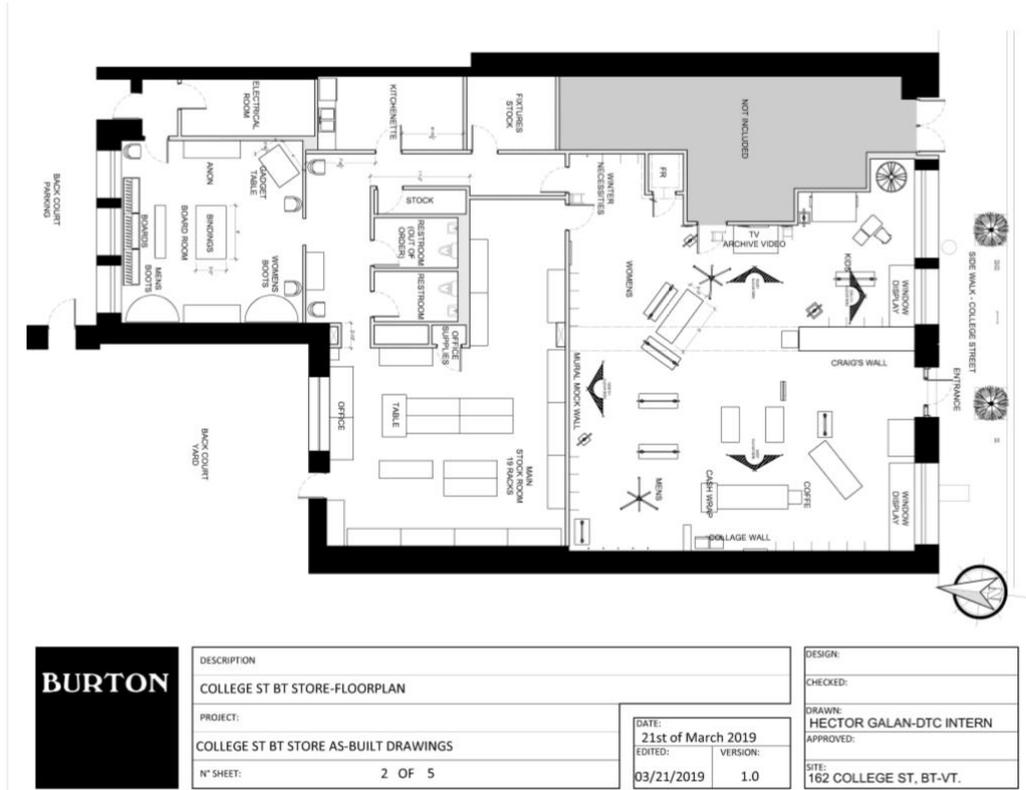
Plano en planta. Fuente: elaboración propia.
